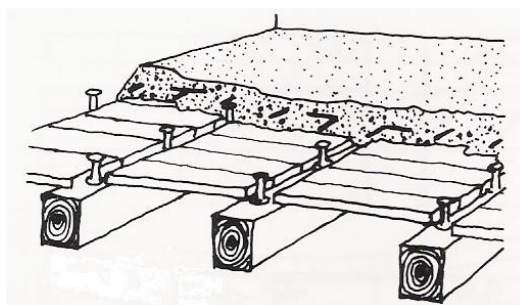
Colocação de lajeta de Betão sobre o pavimento de madeira (Arriaga;2002).
